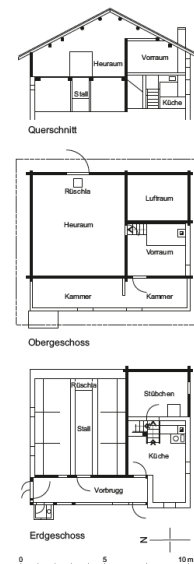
Grundrisse und Querschnitt 1:200.
